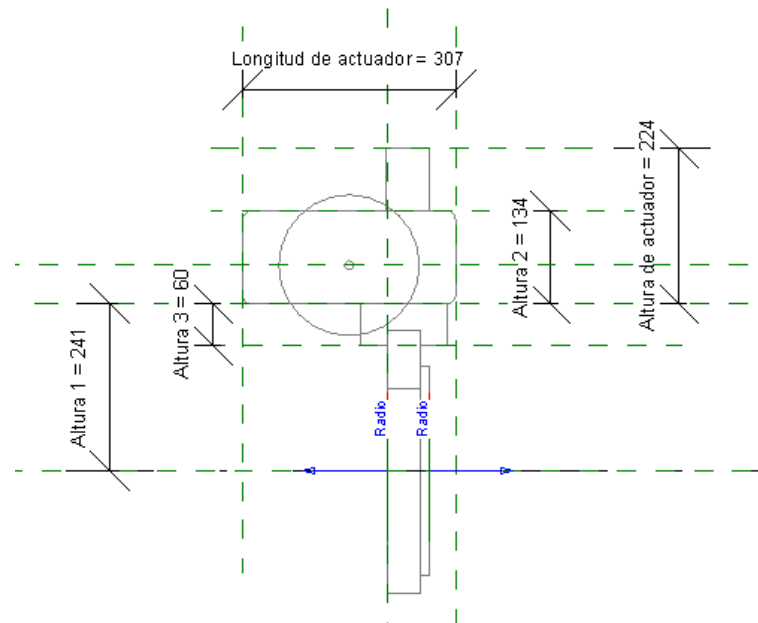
Alzado válvula de compuerta biblioteca Revit
